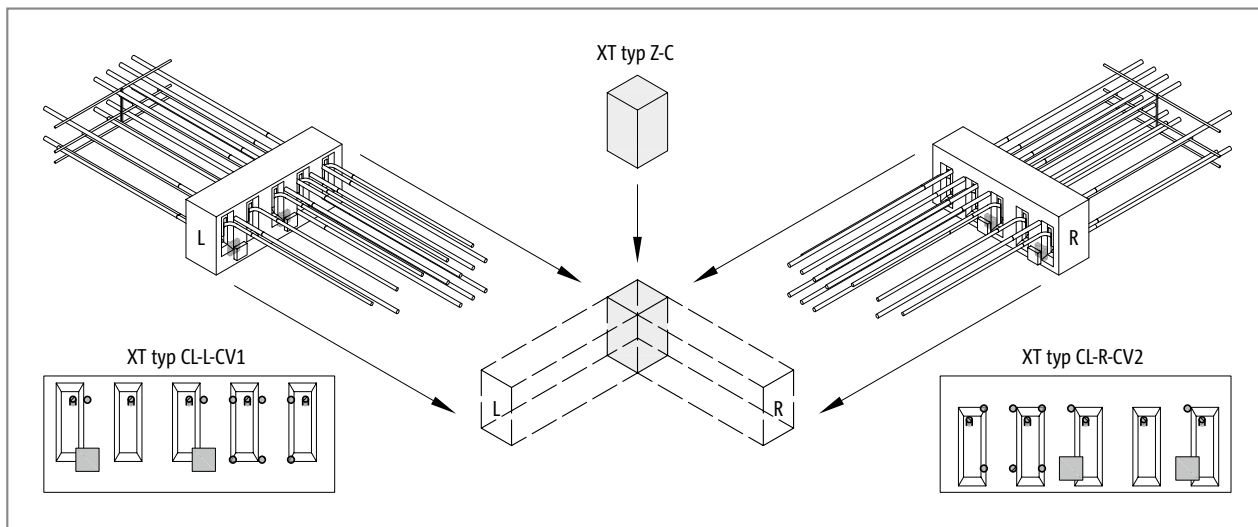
Schöck Isokorb® XT typ CL: Krytí výztuže je volitelné – zde krytí výztuže CV2 vlevo od stanoviště, krytí výztuže CV1 vpravo od stanoviště
